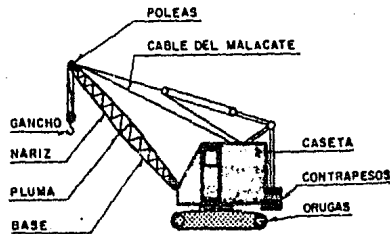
GRUA MOVIL MONTADA SOBRE ORUGAS
